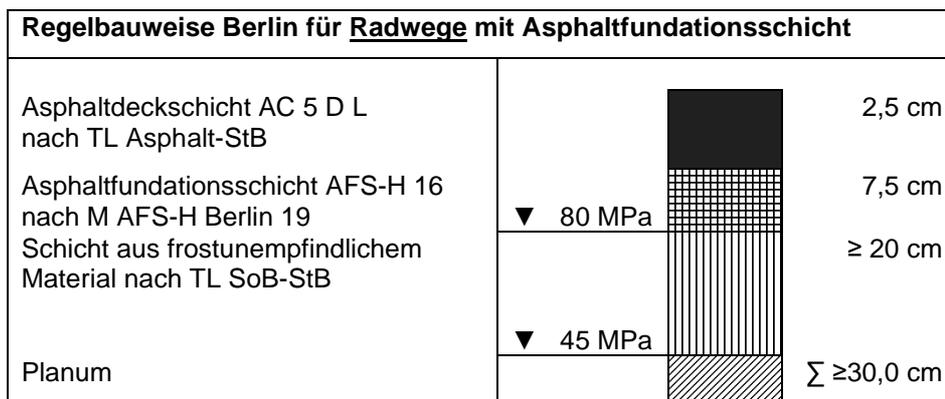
Bauweise für Radwege mit Asphaltfundationsschicht
